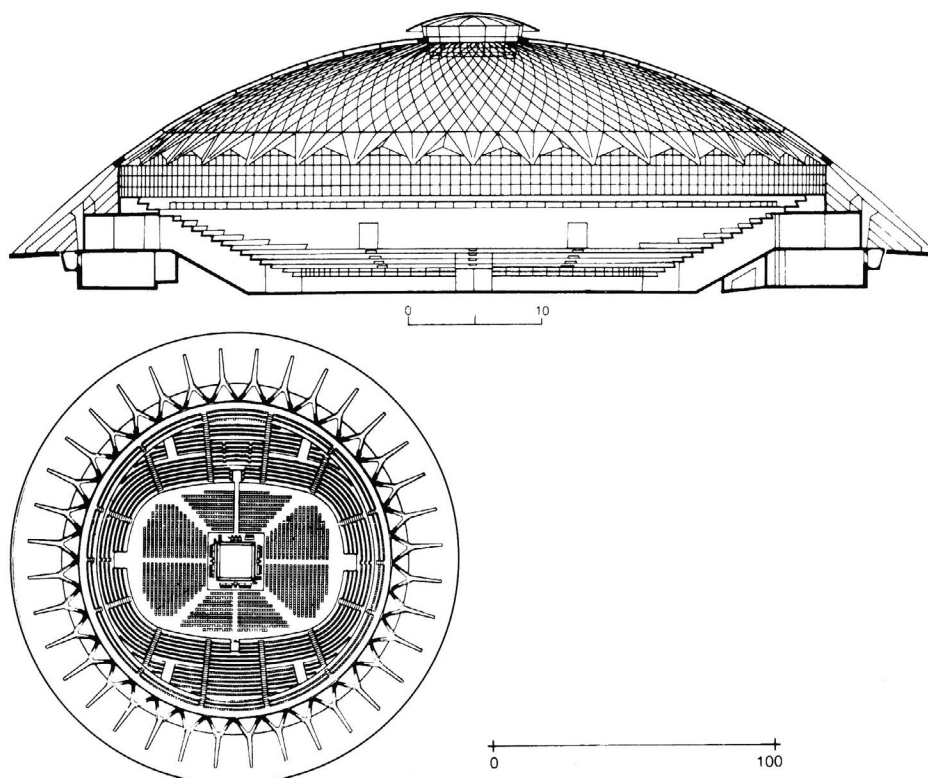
Pallaz-zetto dello Sport, em Roma (Itália), de Pier Luigi Nervi - Perfil e planta
